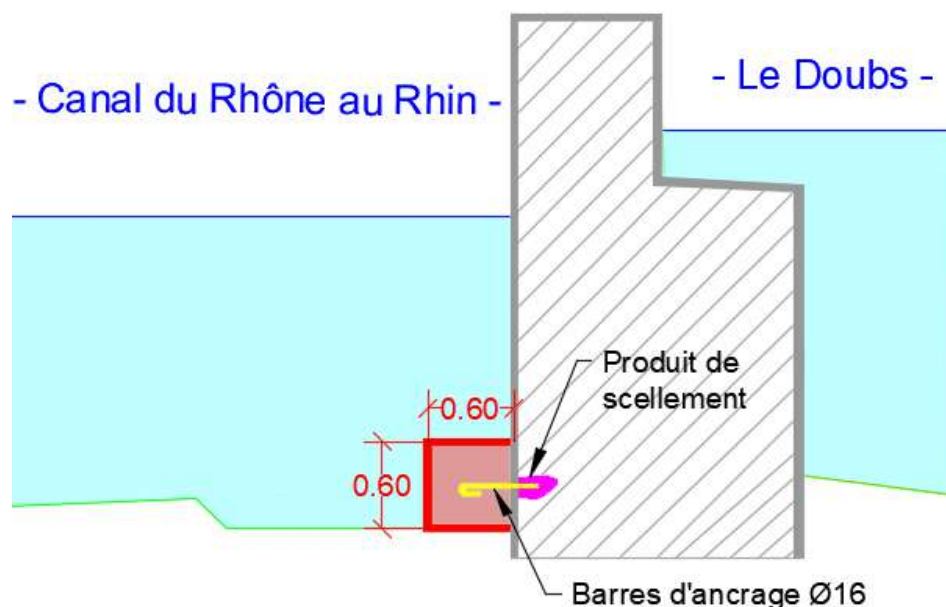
Coupe type de l'ancrage de la longrine en pied du mur
